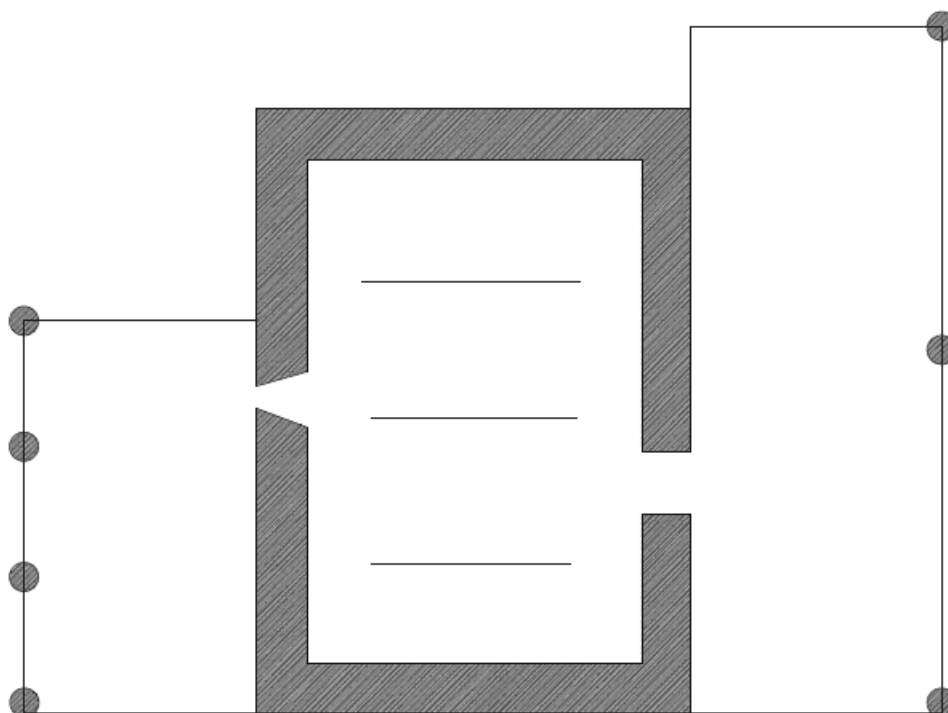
Planta hipotética do Hospital do Espírito Santo (Barcelos). Adaptado de Lousada 2010: 20.
